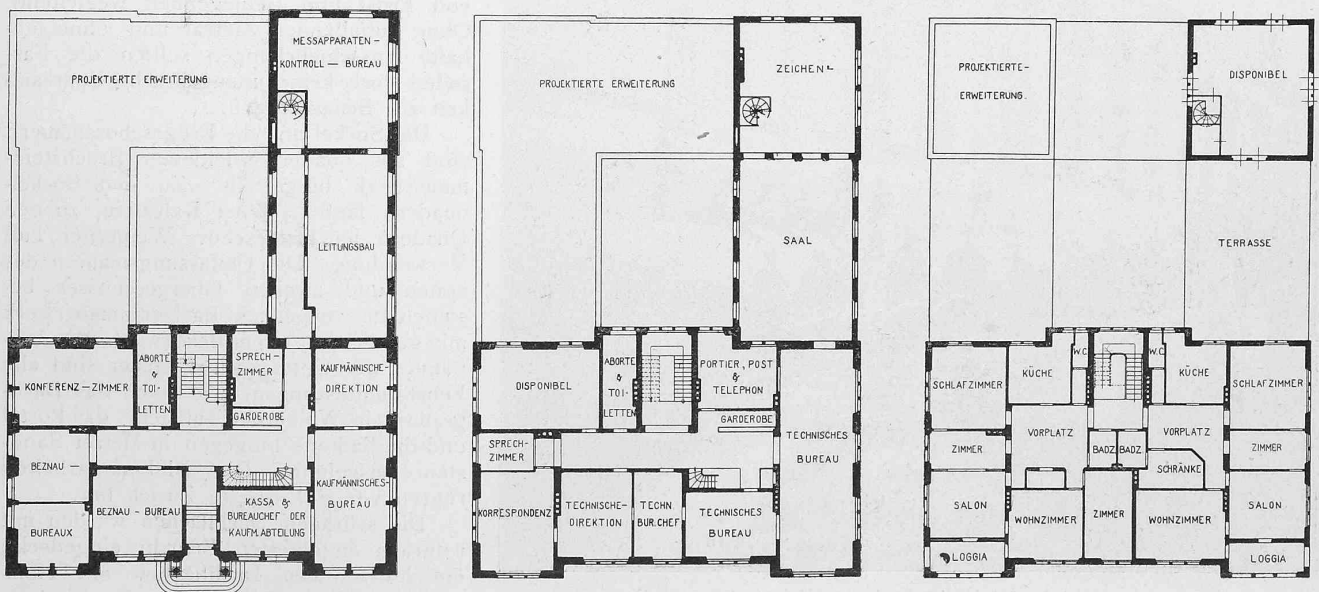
, 2 und 3. Grundrisse vom Erdgeschoss, I. Stock und II. Stock. — Masstab 1 : 500.
